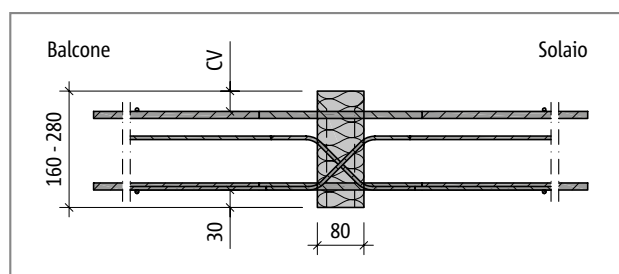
Schöck Isokorb® tipo D, sezione del prodotto
